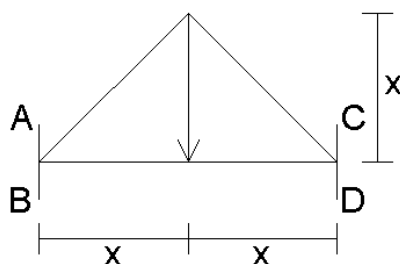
Distribución de cargas de una losa sobre vigas perimetrales.
